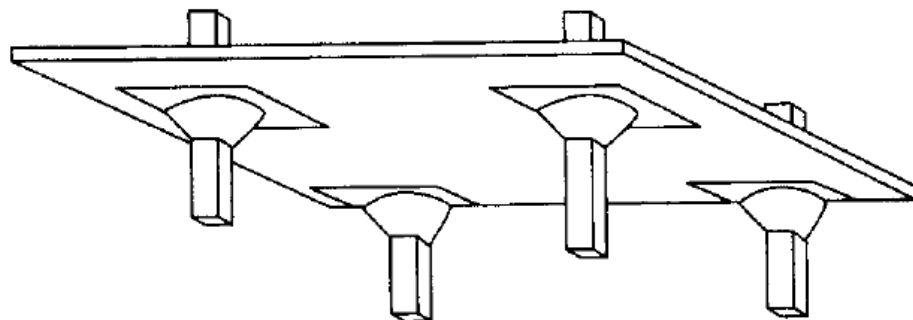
Penerapan Flat Plate Pada Gedung Parkir
